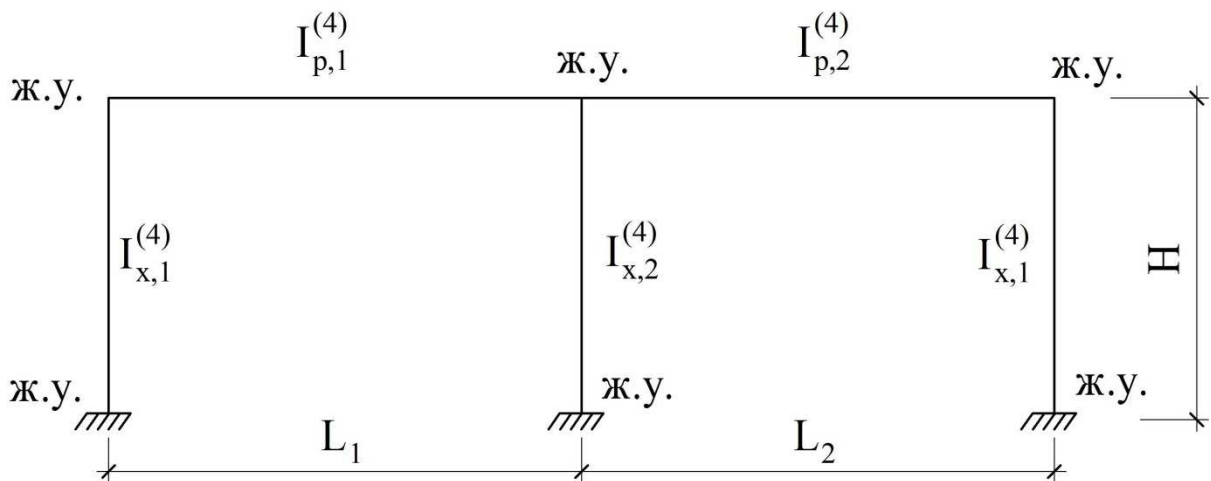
Расчетная схема двухпролетной свободной поперечной рамы: верхние узлы и нижние - жесткие; поперечные сечения колонн - постоянные; ригеля - эквивалентные стержни
